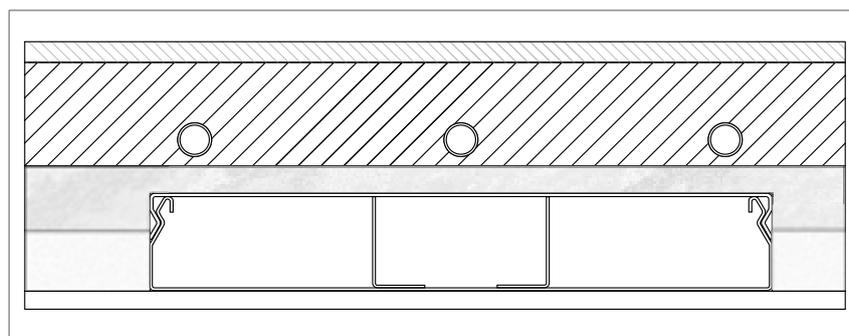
Estrichüberdecktes Bodeninstallationssystem UK
